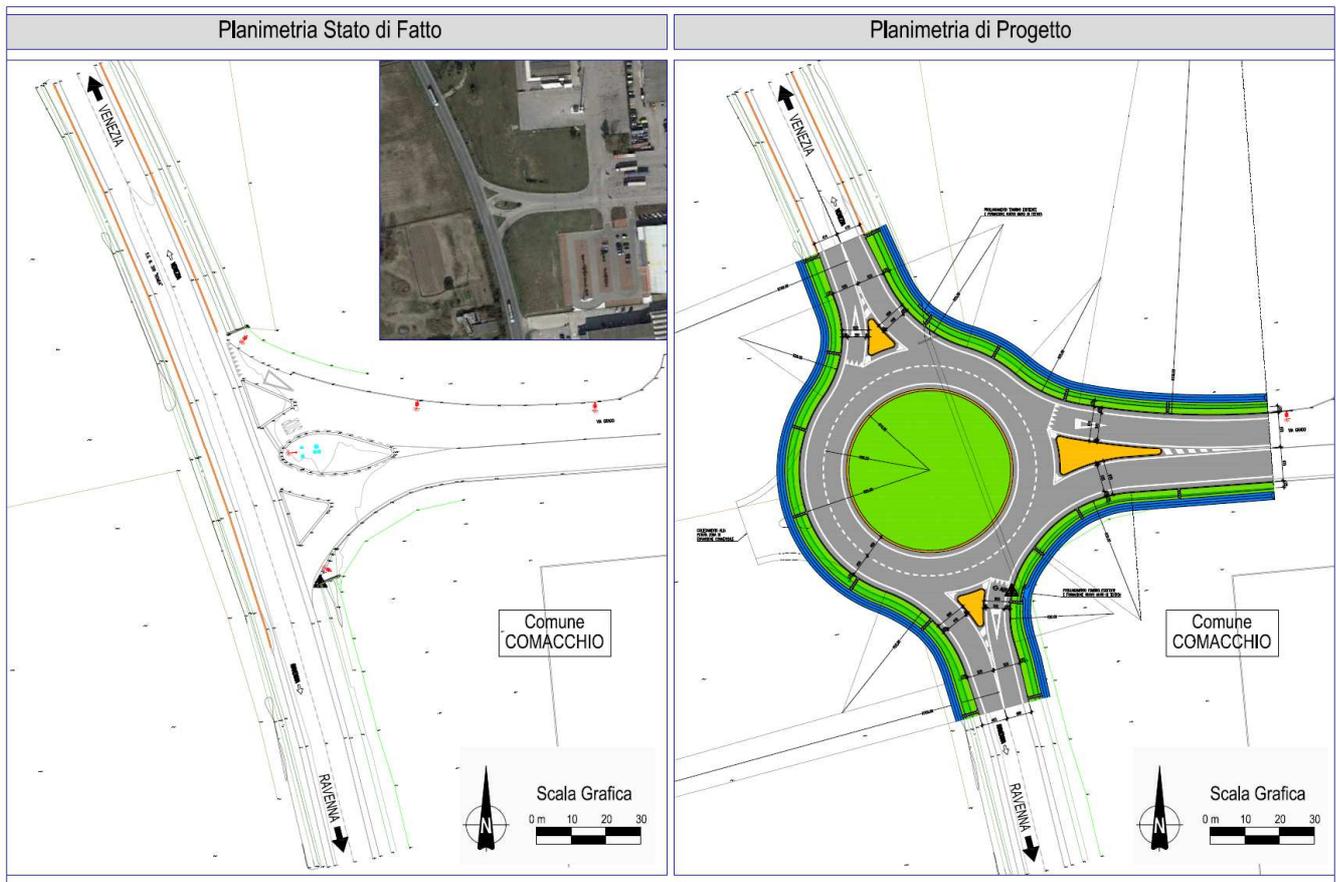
Intervento n° 11 – Planimetria Stato di fatto - Progetto
